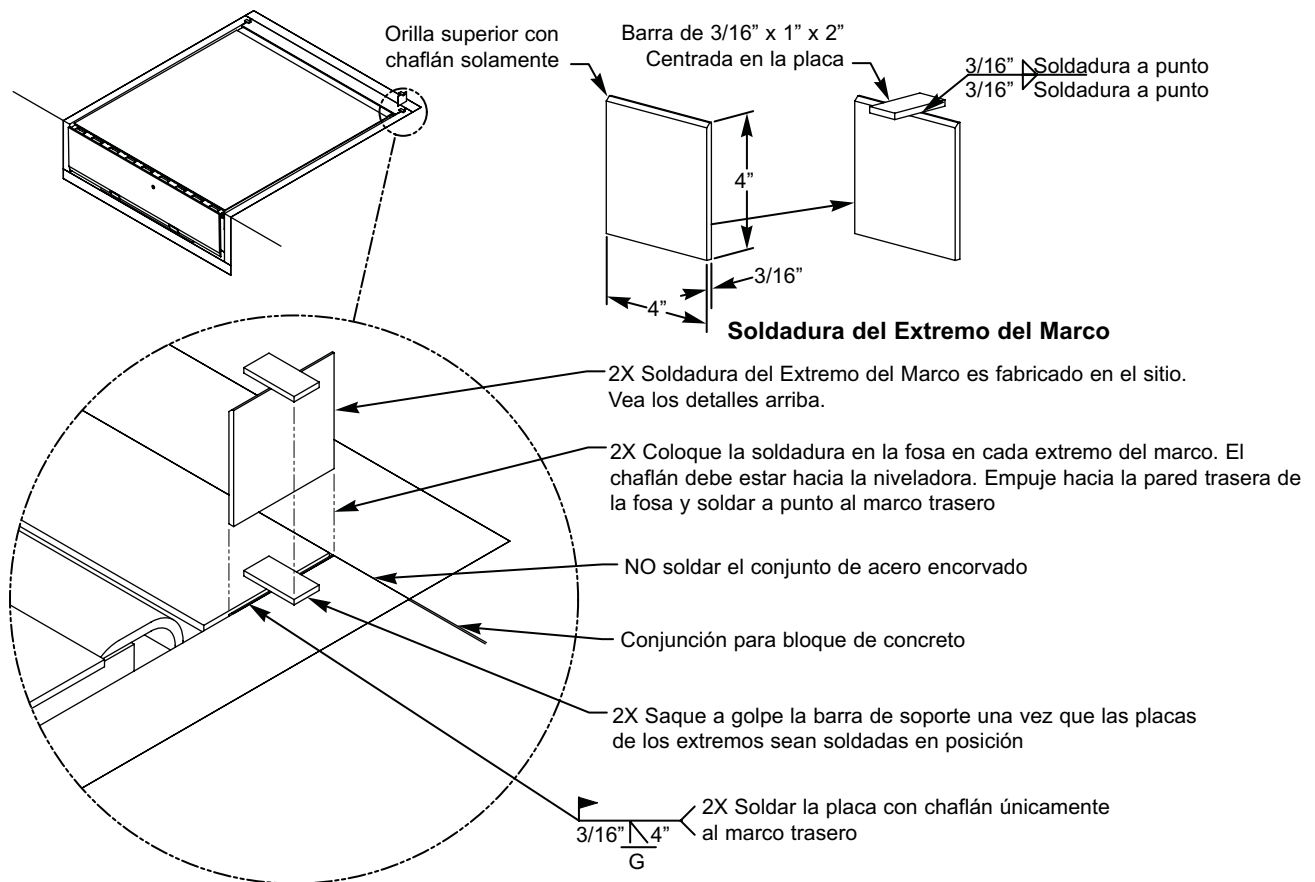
DETALLES DE SOLDADURA DE CUÑAS
